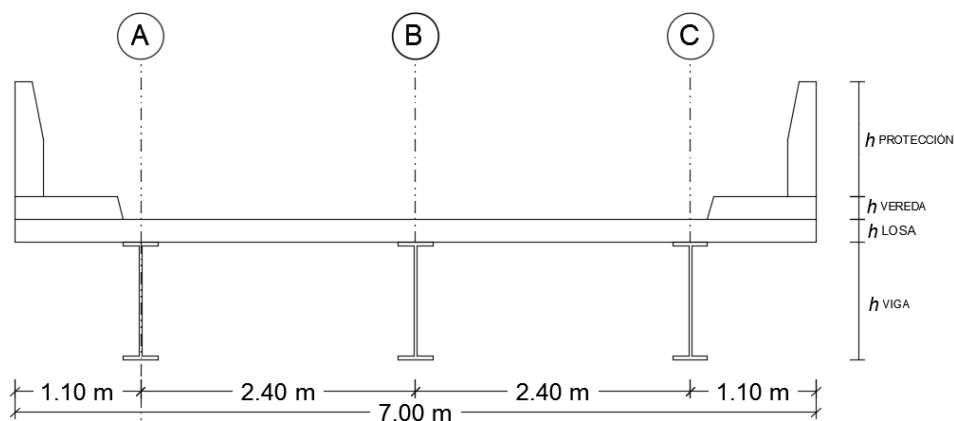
Sección transversal de la superestructura. Elaborado por: El autor
